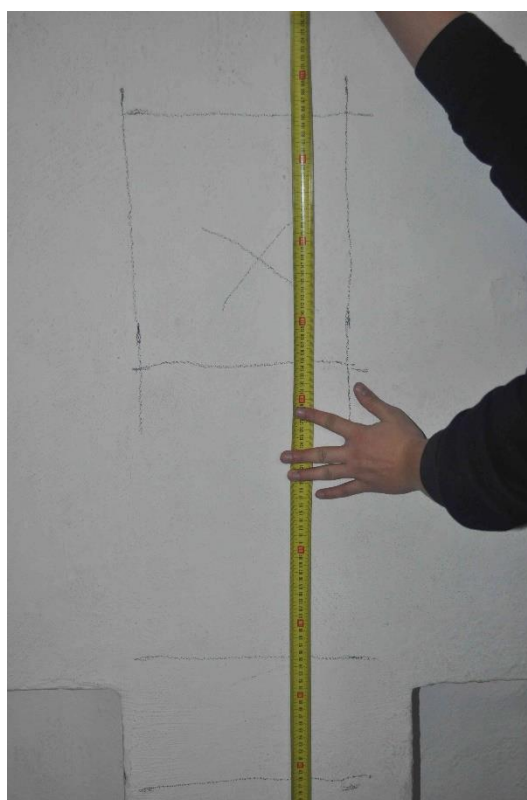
Dispunere etrieri pe zona curentă a stâlpului B/3
